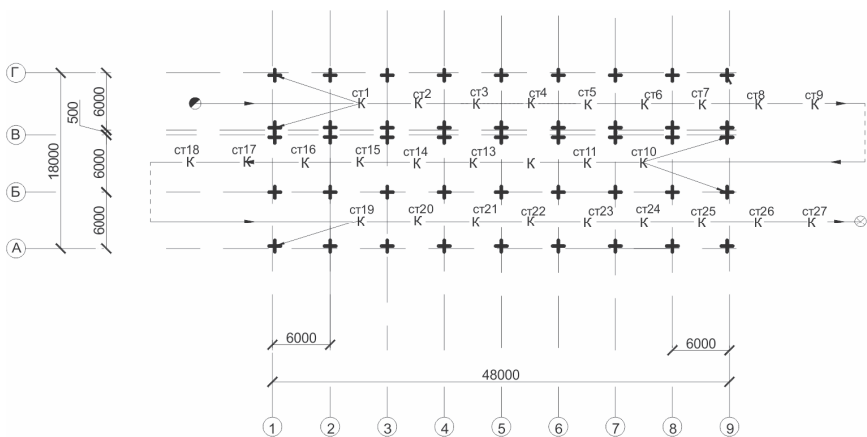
Схема проходки крана в процессе монтажа колонн
